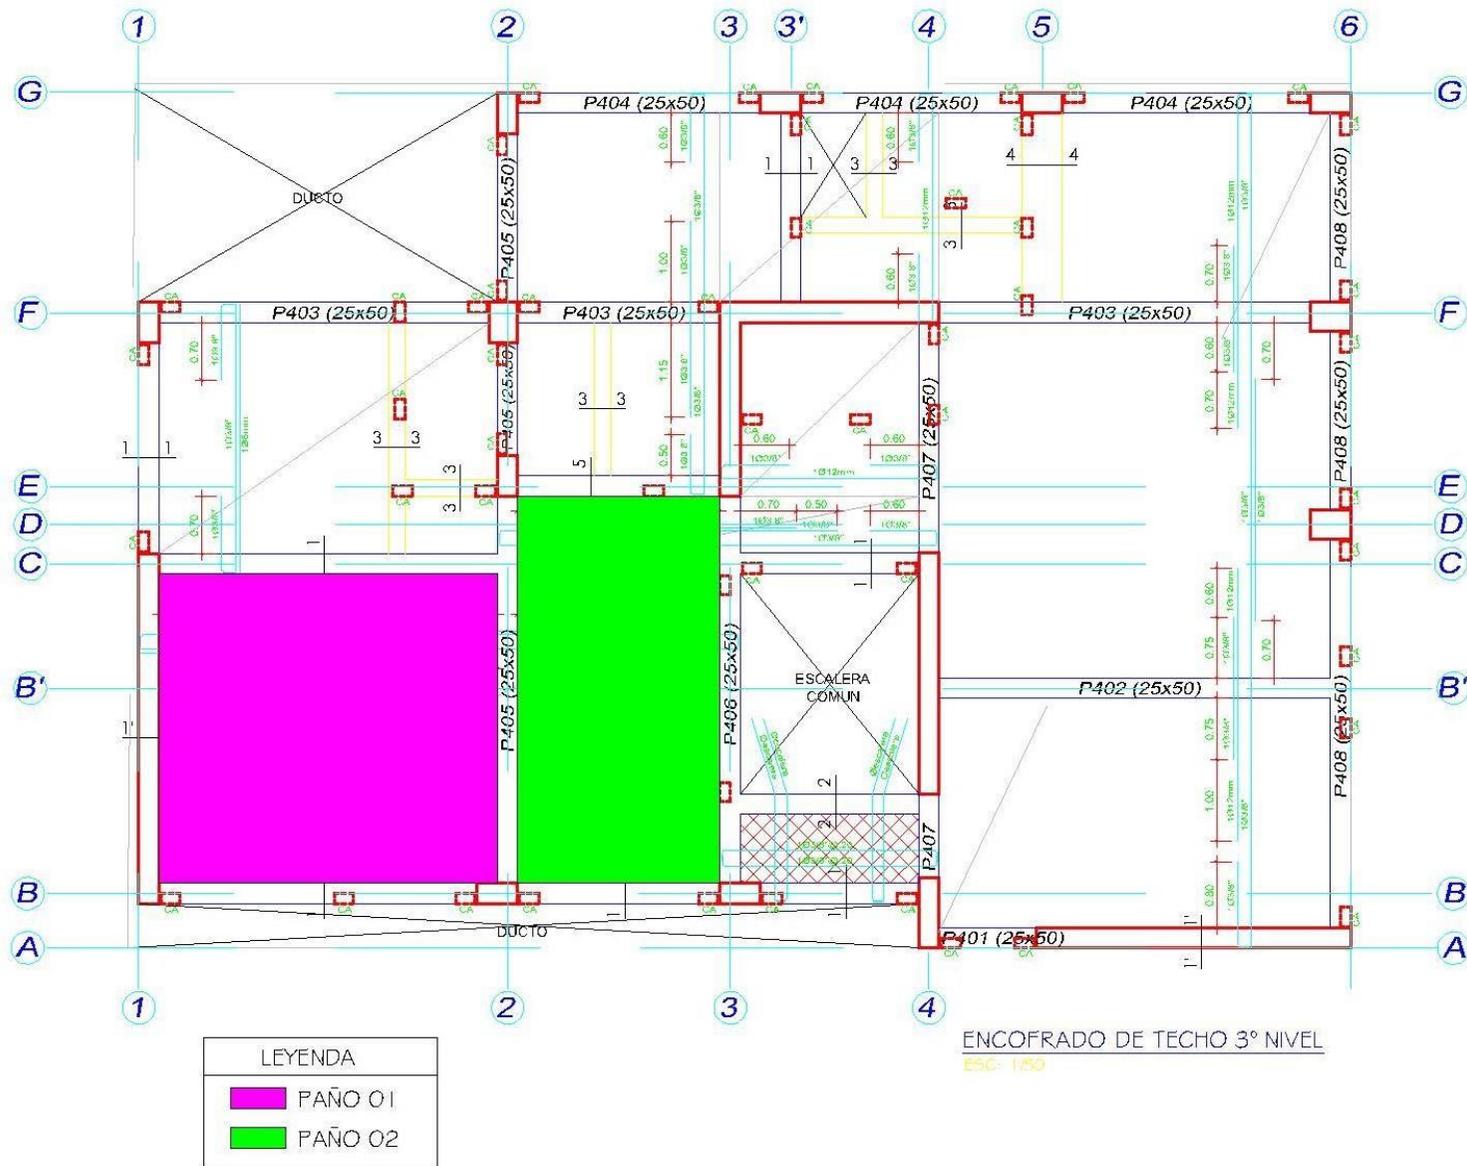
Plano de encofrado tradicional de techo 3° Nivel de la obra "Residencial Home Green".
